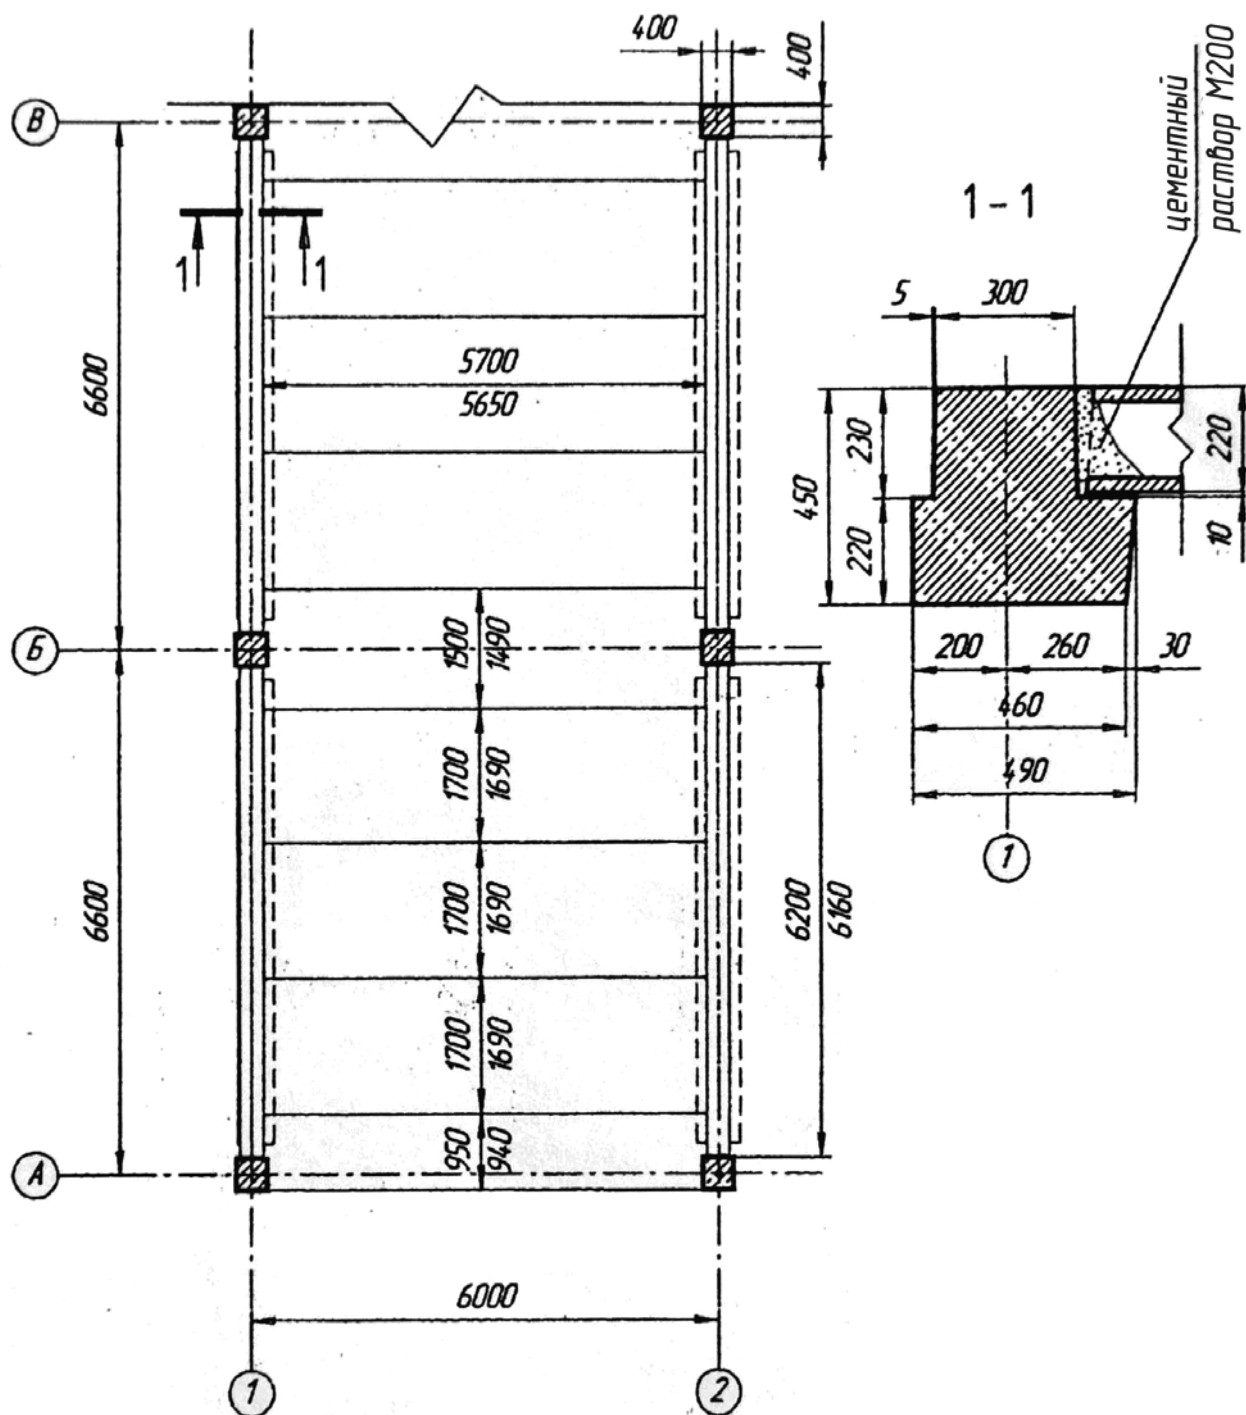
Компонировка конструктивных элементов перекрытия
